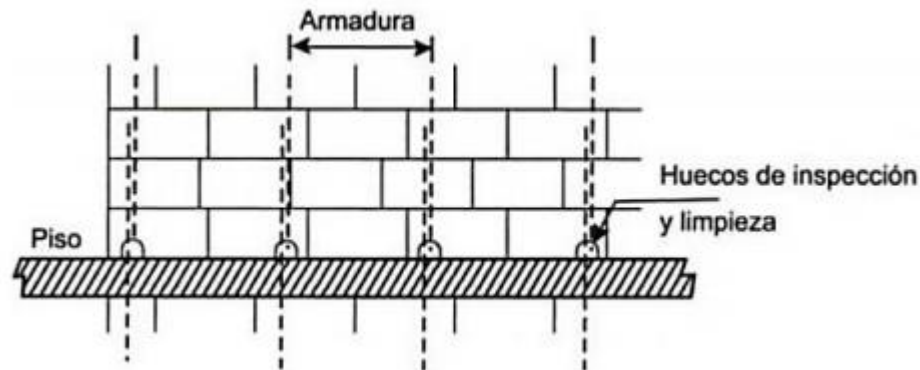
Detalle de muros de albañilería armada Según (Gallegos & Casabonne, 2005)
